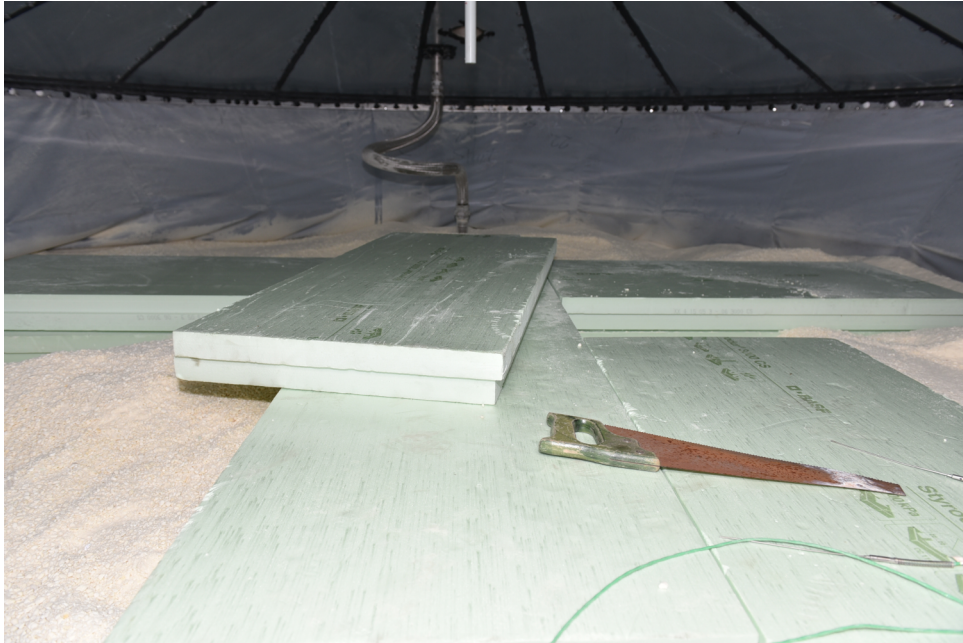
Demonstrator, Dachraum, Schwimmdecke mit Einbauten zur Begehung (XPS-Wärmedämmplatten) während der Montage, 13.07.2017
